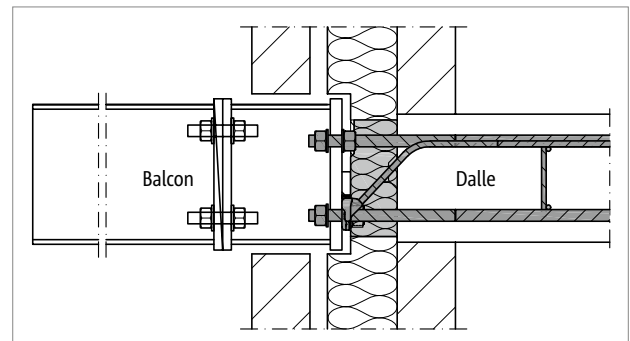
Schöck Isokorb® T type SK : Corps isolant dans l'isolation du noyau ; la pièce de liaison sur site entre l'élément Isokorb® et le balcon permet une certaine flexibilité dans le processus de construction
